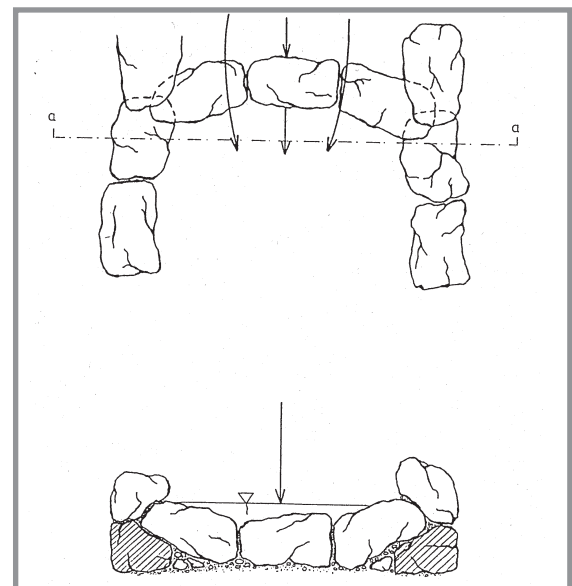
Ökologische Grobsteinschwelle; Grundriss (oben) und Querprofil (unten)
